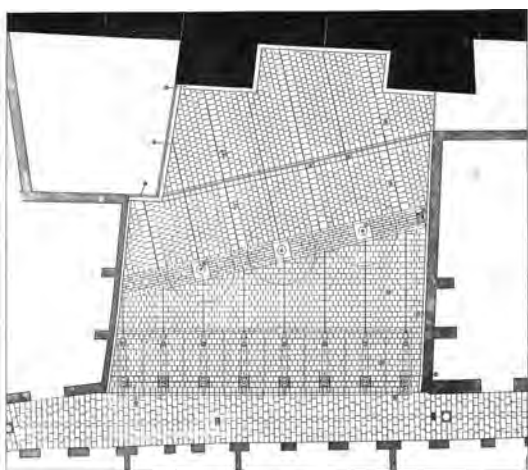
/ BETH GALÍ, Plaça al Carrer de la Palla, Barcelona.
